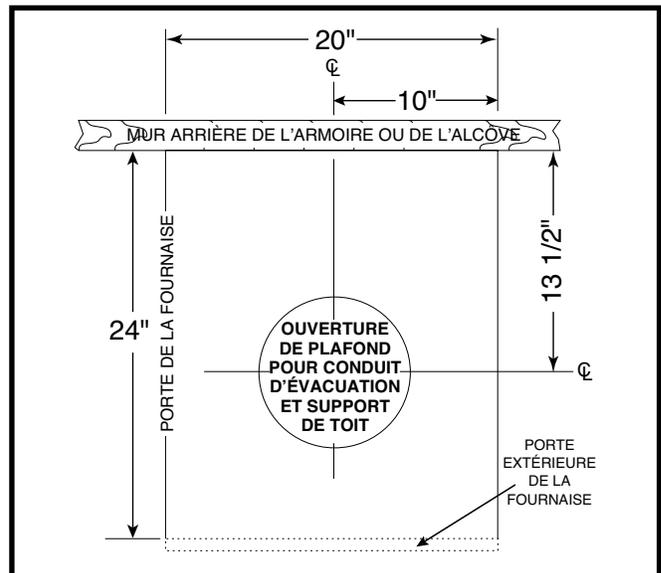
Dimensions de coupe pour le conduit d'évacuation et le support de toit
